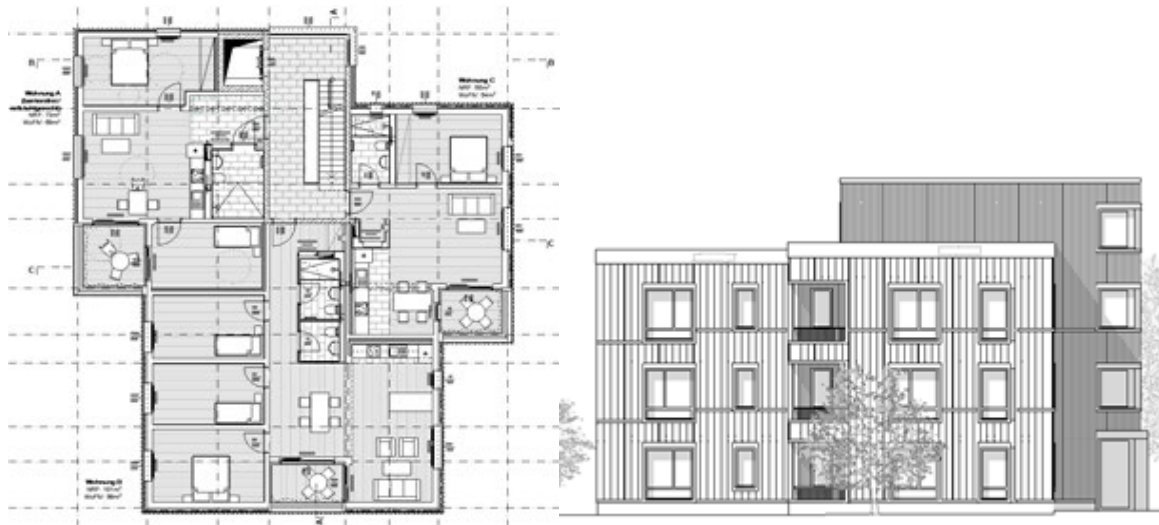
Grundriss Regelgeschoss Grundriss Regelgeschoss + Ansicht Ost, von Albert-Einstein-Straße
